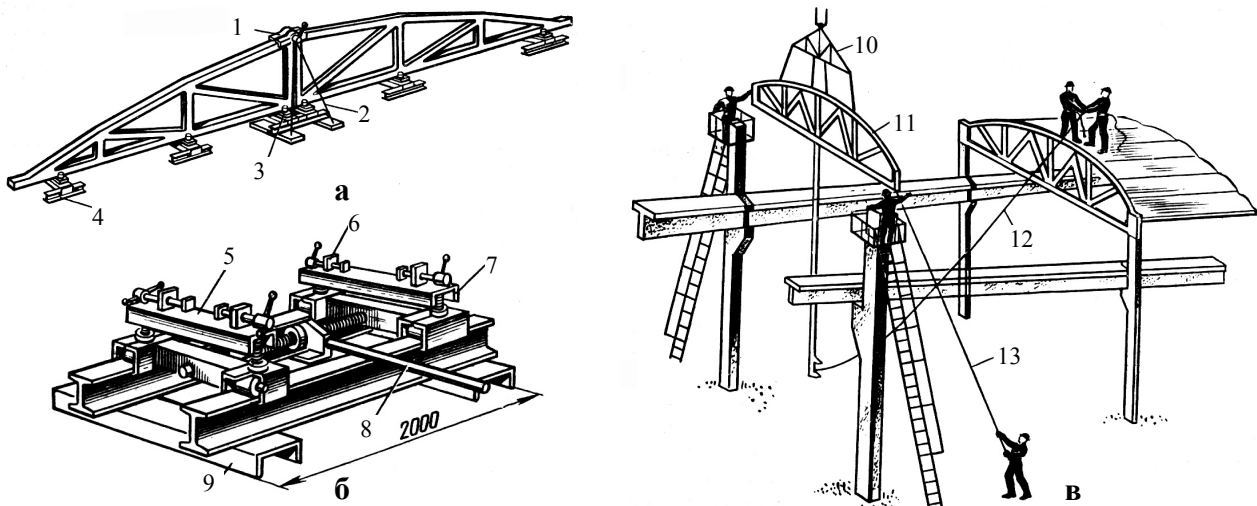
Укрупнювальне збирання: а – кроквової ферми; б – кондуктора; в – монтаж ферм: 1 – струбцина; 2 – розтяжка; 3 – кондуктор; 4 – роликівна опора; 5 – опорний столик; 6 – регулювальний гвинт; 7 – напрямний швелер; 8 – домкрат; 9 – рама; 10 – траверса; 11 – кроквова ферма; 12, 13 – канати
